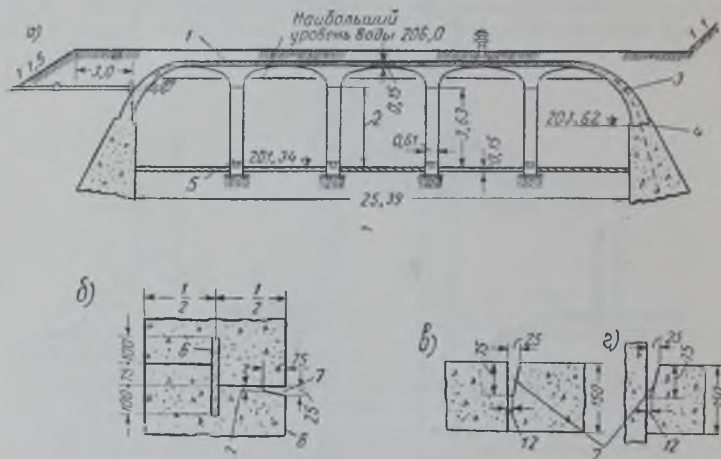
Неармированное бетонное покрытие резервуара в Спрингфильде, Вермонт (из Eng. News-Record, Sept. 23, 1943, p. 105)
